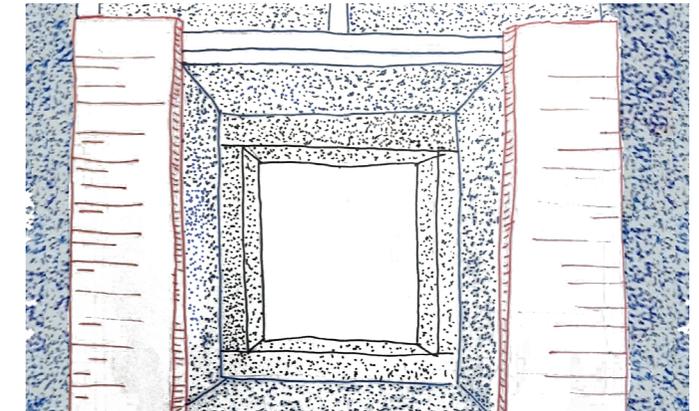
Aggiunta finale dei casseri in legno come supporto per la creazione delle spalle.
